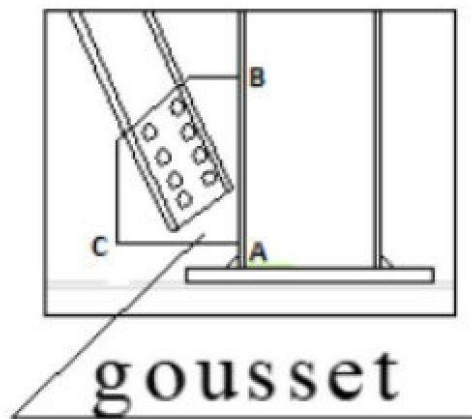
Assemblage de gousset soudé (1er type)
